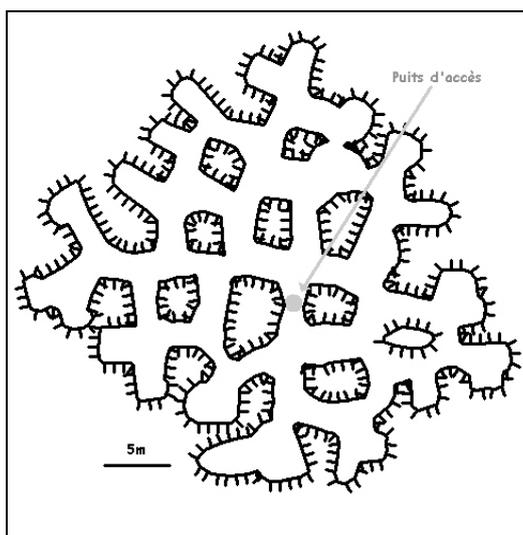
Schéma en plan d'une marnière à puits exploitée par chambres et piliers
